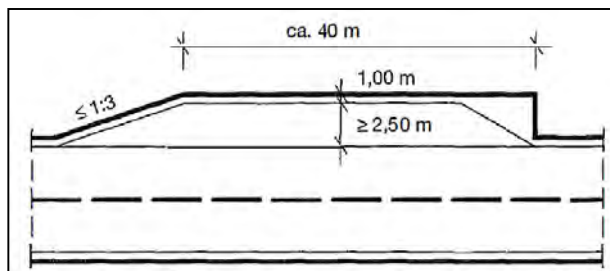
Grundriss einer Pannenbucht an einer Richtungsfahrbahn in Tunneln (RABT 2003)
